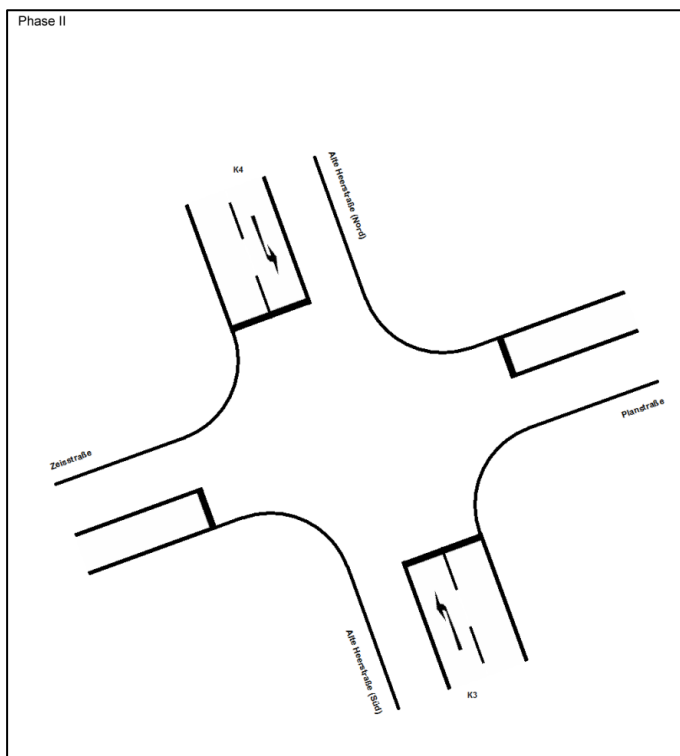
Phase 2 am Knotenpunkt Alte Heerstraße (B3) / Zeissstraße / Planstraße
